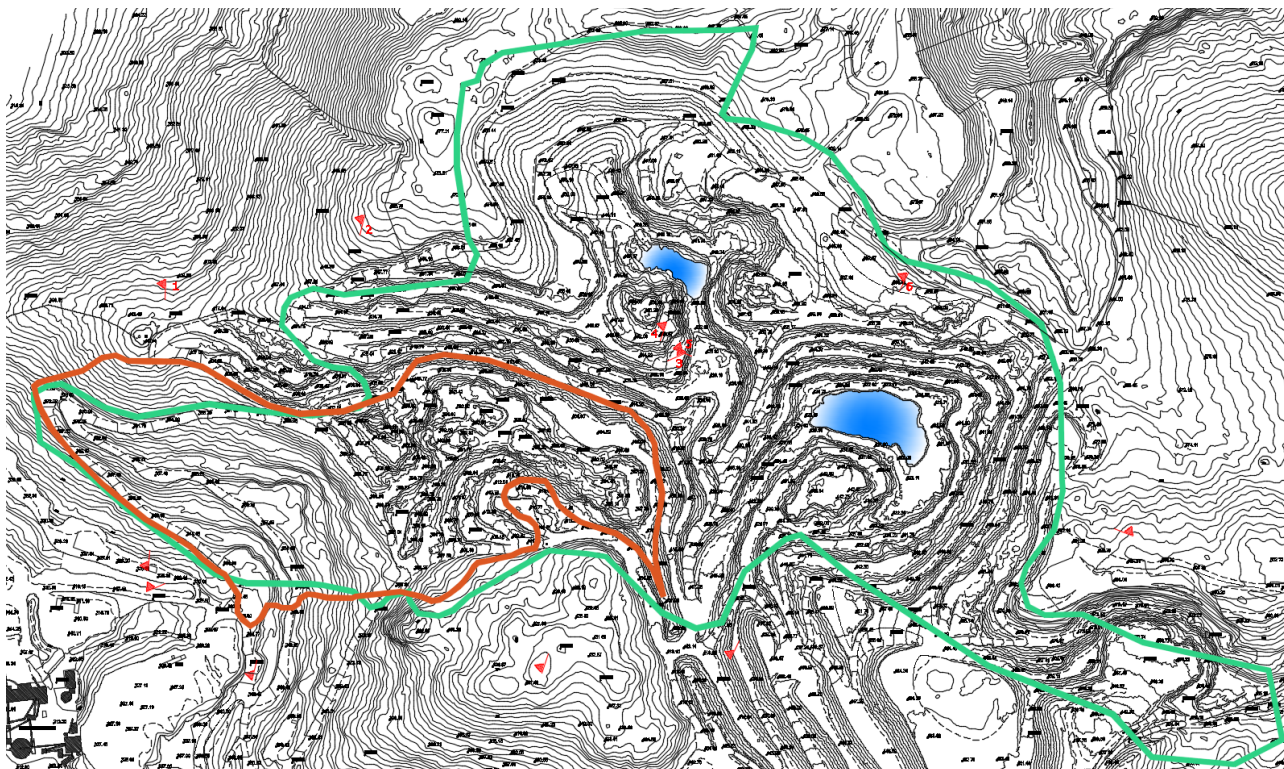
cantiere di Ispaduleddas. In verde l'area in scavo autorizzata, in rosso l'area in scavo prevista in progetto
